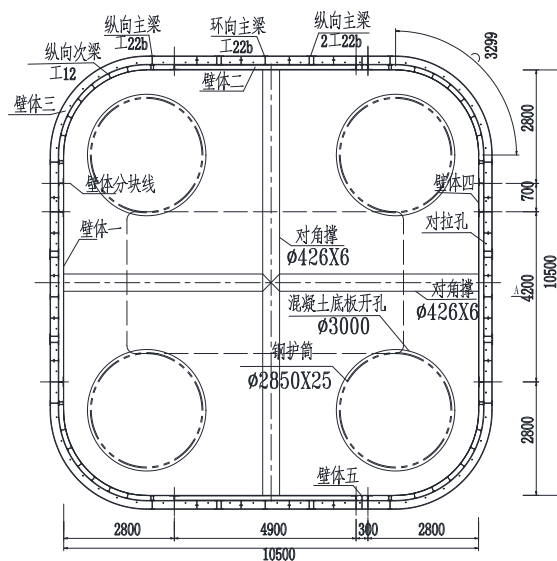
10.5 m × 10.5 m × 4 m 钢吊箱结构平面布置图 (mm)
